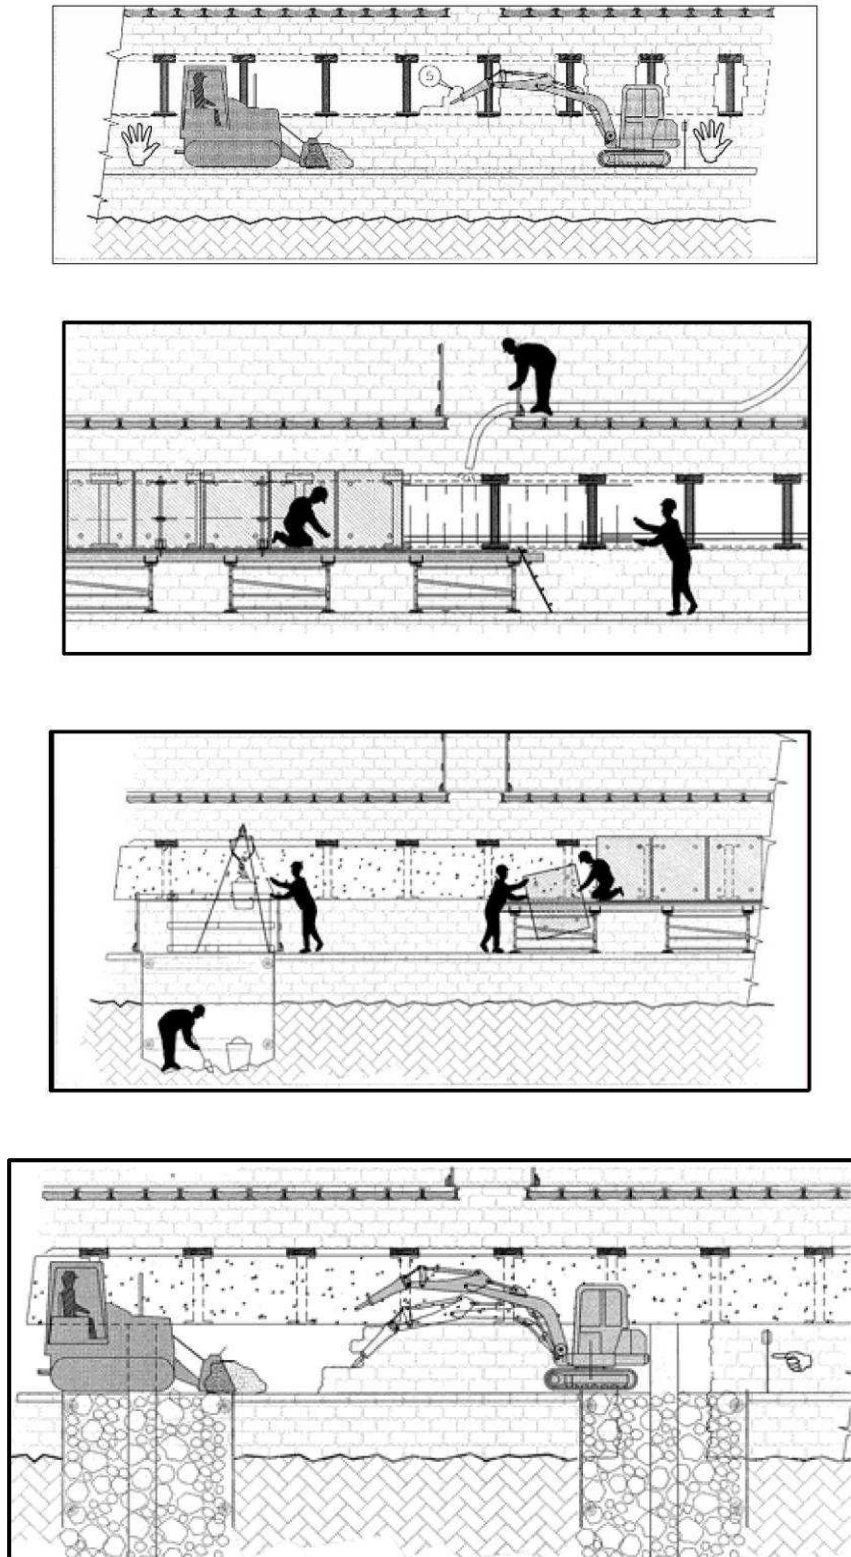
Deconstrucción de paredes mediante banquetas
